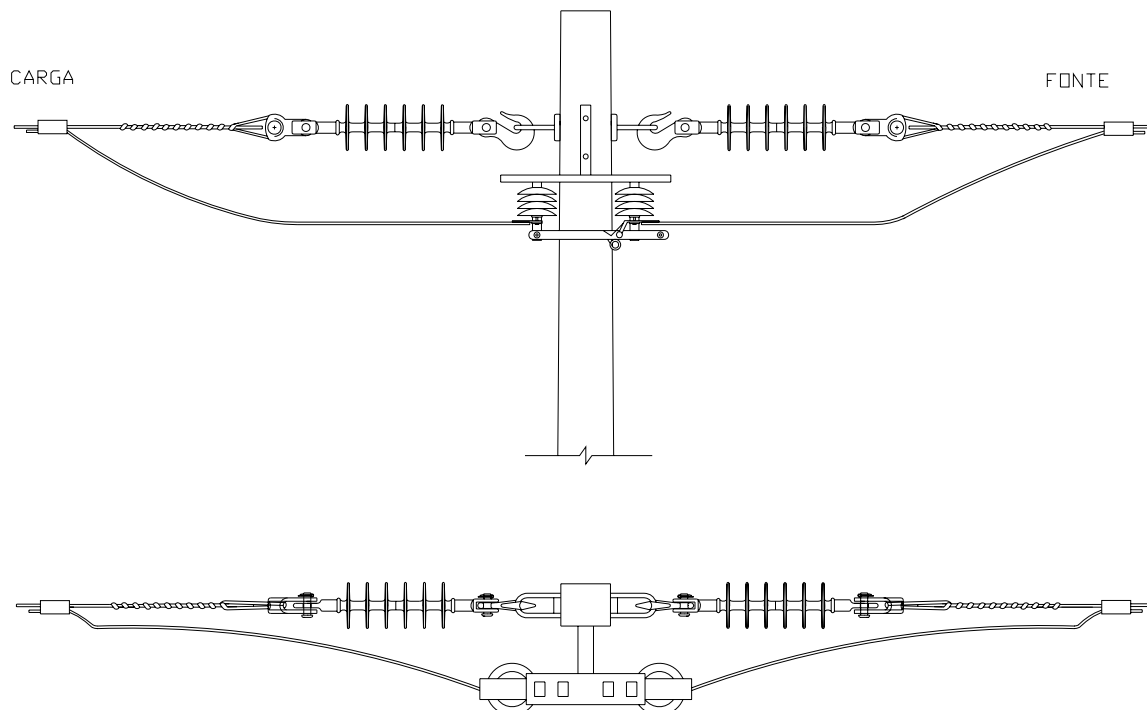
Estrutura U4 chave faca (manobra) (montagem alternativa)
